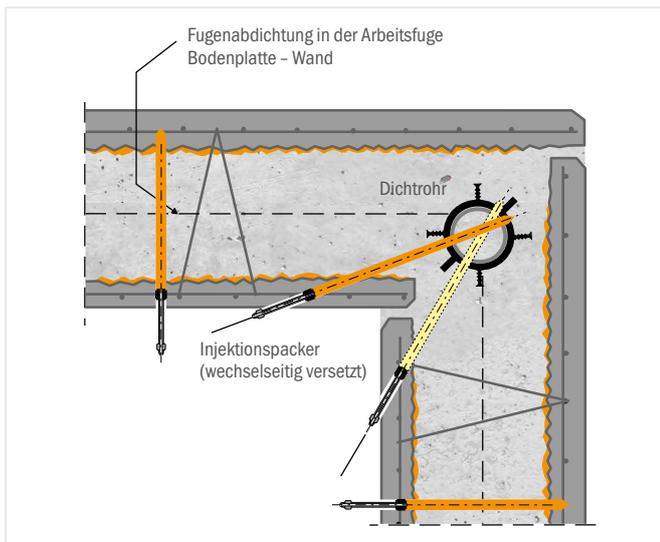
b: Nachträgliche Abdichtung einer Elementwanddecke mit Dichtrohr durch Injektion [8]
